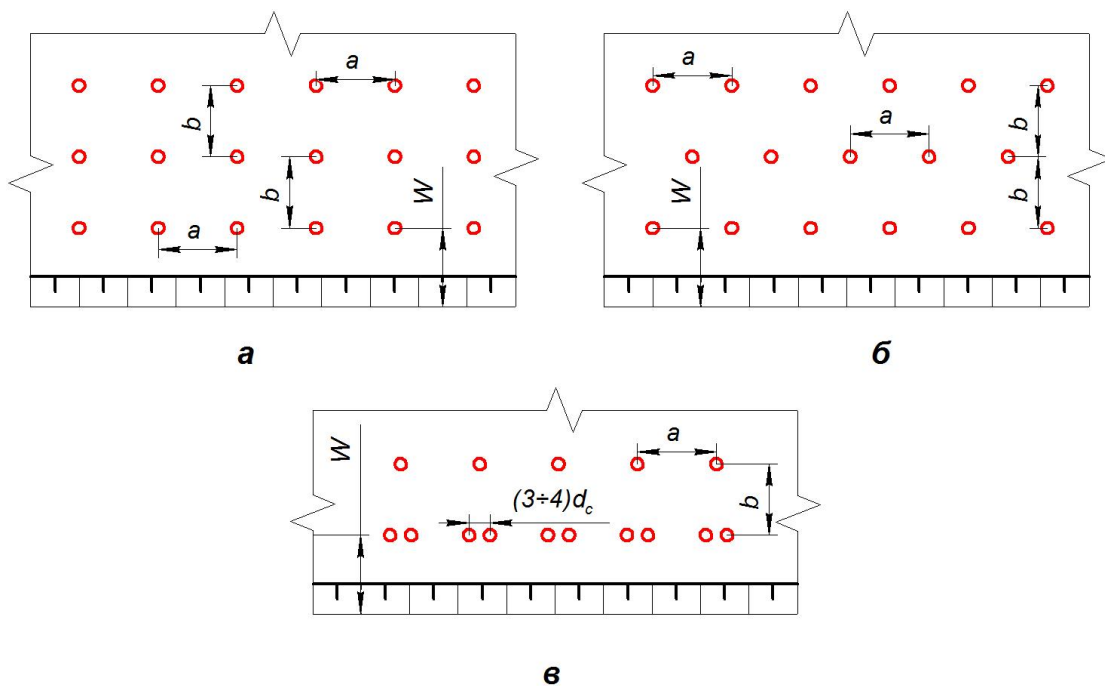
Схеми розташування свердловин на уступі: а) і б) – багаторядна по квадратній і «шаховій» сітці; в) з парнозближеними свердловинами в першому ряду
